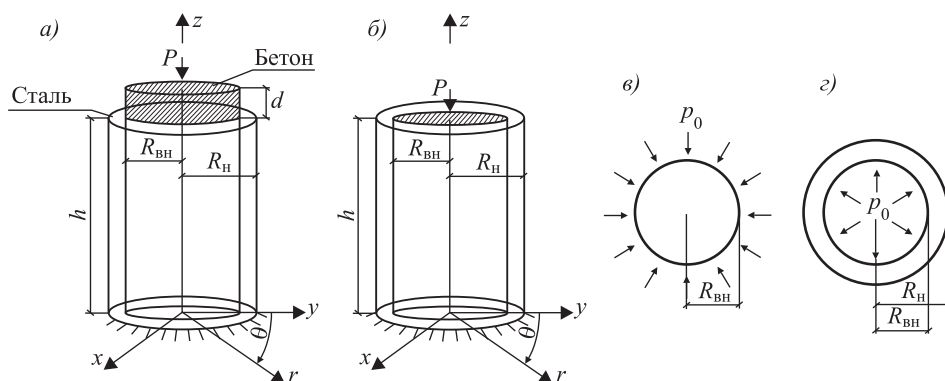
Расчетная схема предварительно напряженной трубобетонной стойки
